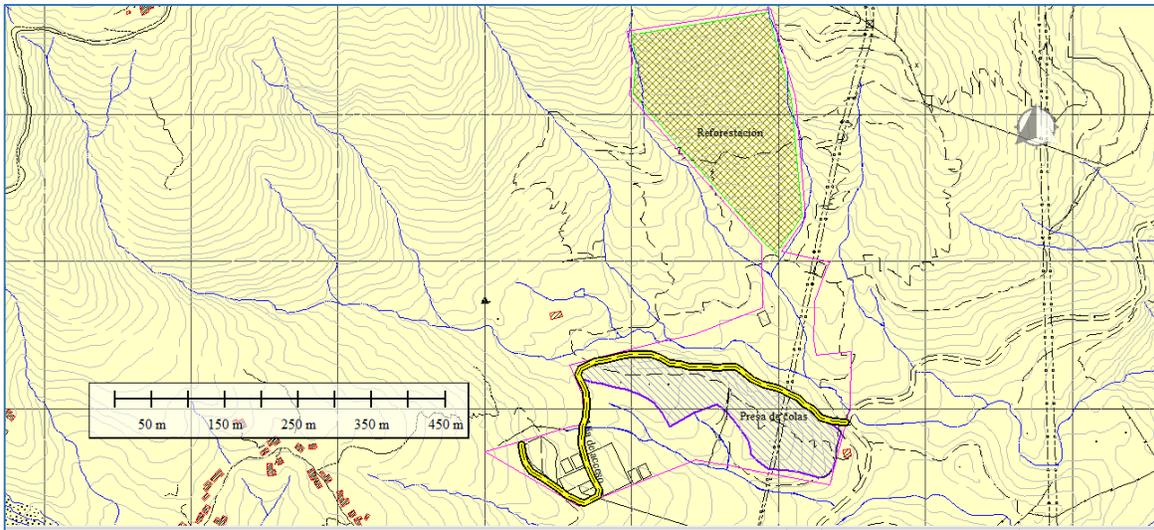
Vía de acceso secundaria proyectada, bordeando la presa de colas hasta acopio.
